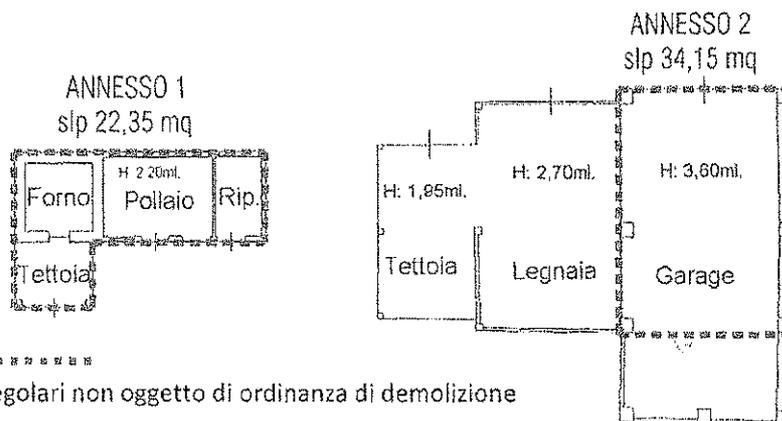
calcolo superficie lorda di pavimento degli annessi regolari scala 1:200
